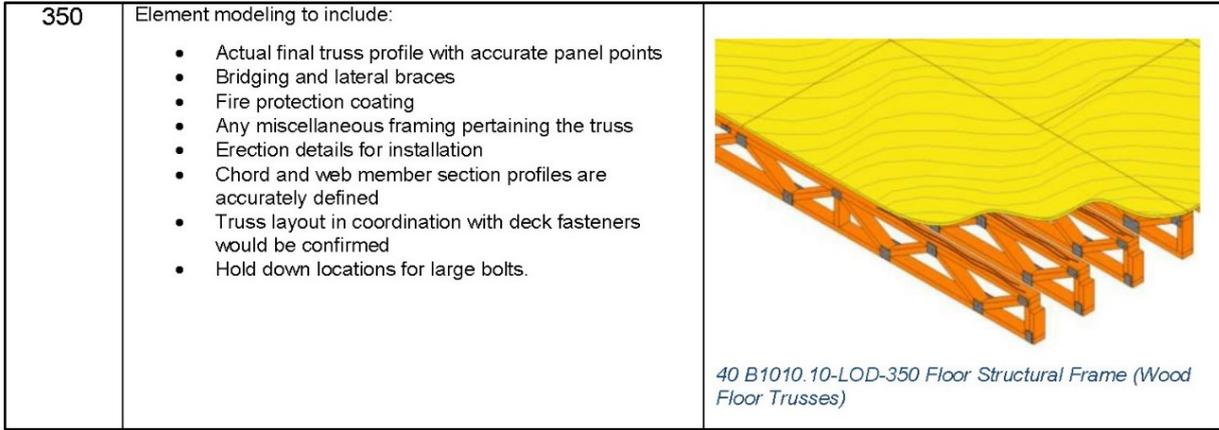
Pavimento Estrutural assente em Trelças de Madeira, LOD350 [Retirado de (BIMForum, 2015b)]
